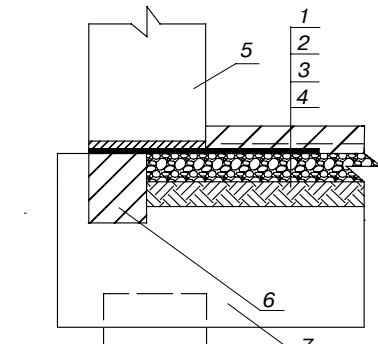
Фрагментированный барьер (плита пола, опирающаяся на ростверк): 1 – монолитный, армированный дорожной сеткой бетон; 2 – полоса рулонного гидроизоляционного материала; 3 – слой щебня, пролитый расплавленным битумом до полного насыщения; 4 – уплотненный грунт; 5 – наружная цокольная панель, опирающаяся углами на балки ростверка; 6 – дополнительная поперечная балка ростверка; 7 – поперечная балка ростверка
